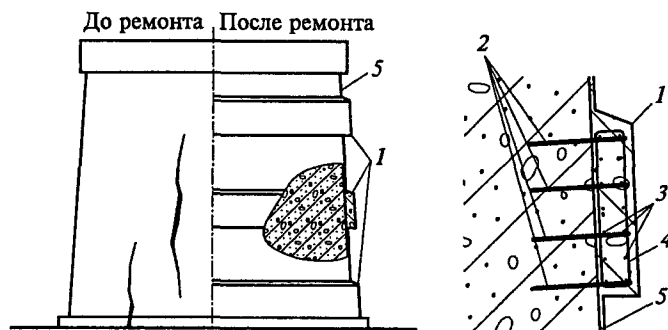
Ремонт промежуточной опоры железобетонными поясами:
